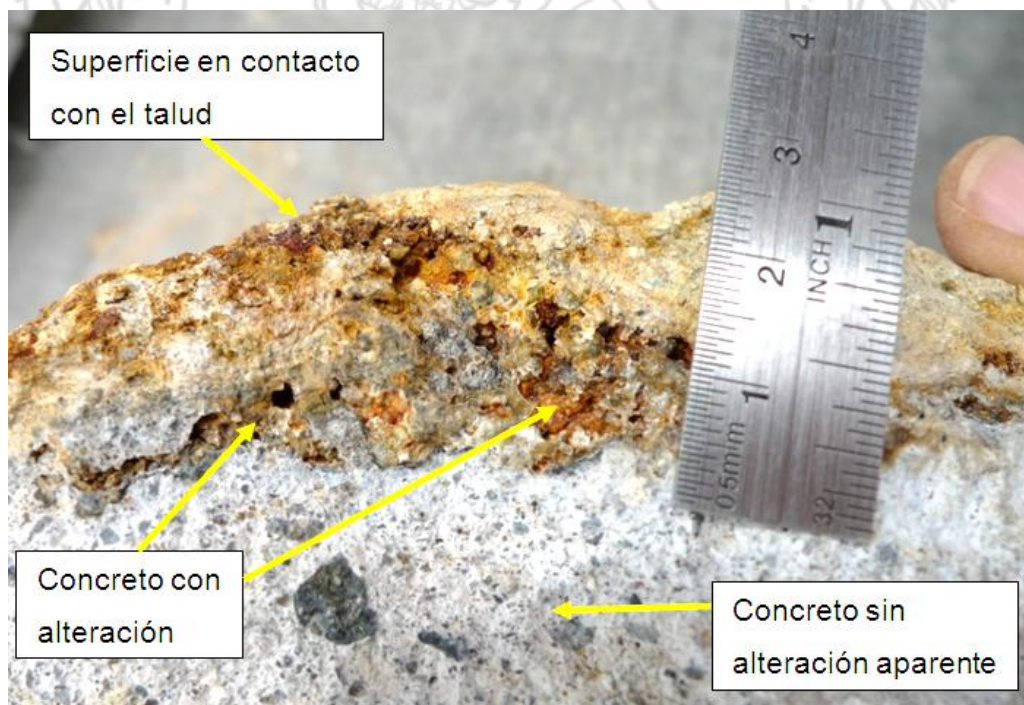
Detalle del deterioro del concreto en la superficie que estuvo en contacto con el drenaje ácido del talud. En este caso la zona de alteración varía entre 1,0 – 1,5 cm aproximadamente.
